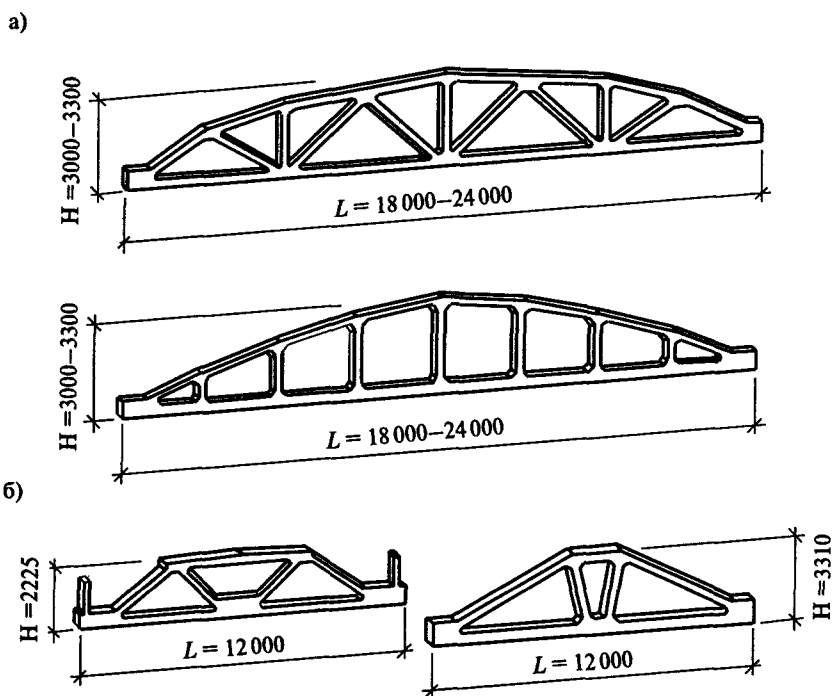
Номенклатура основных типовых конструкций железобетонных ферм производственных зданий: а) стропильные фермы; б) подстропильные фермы
